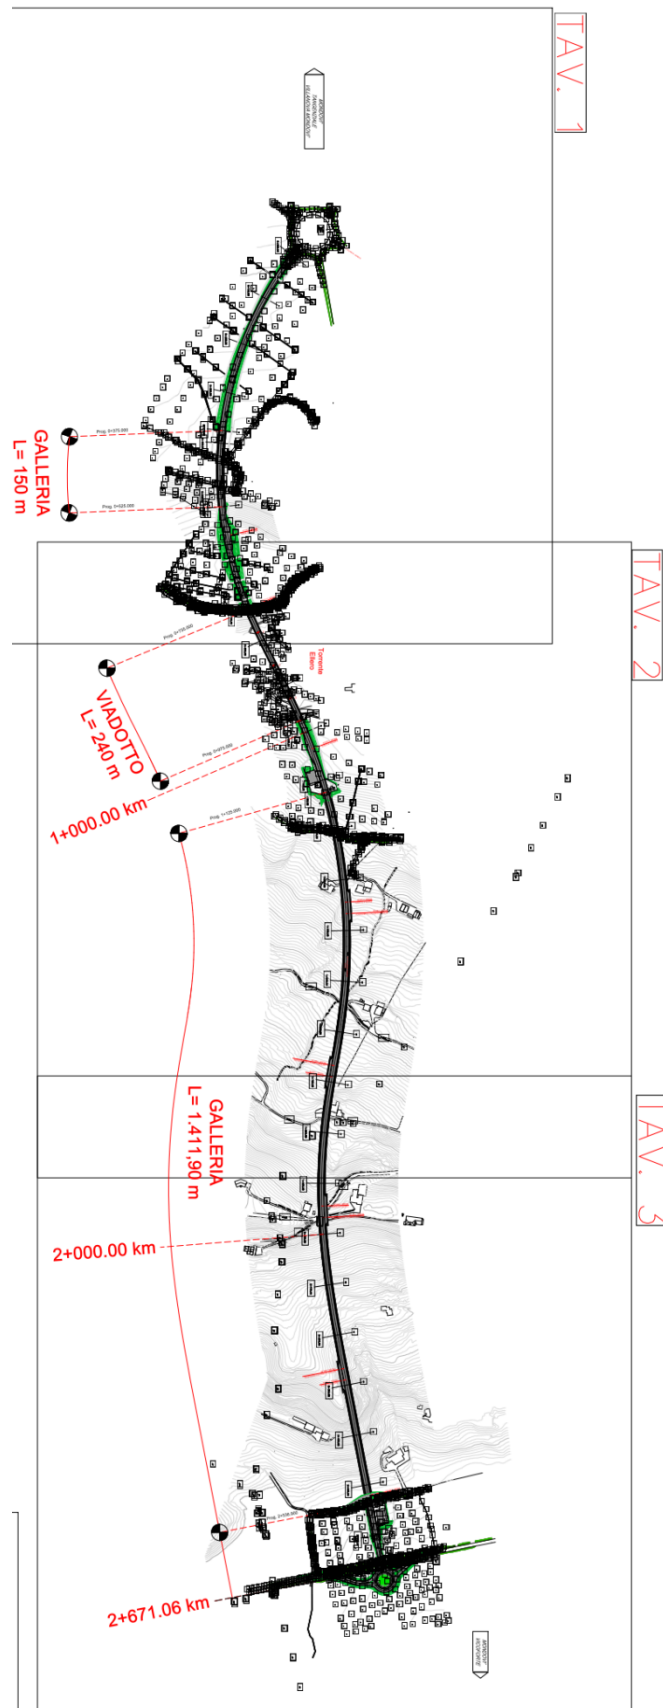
Planimetria d'insieme. Estratto 09.03_P01_PS00_TRA_PL01_A
